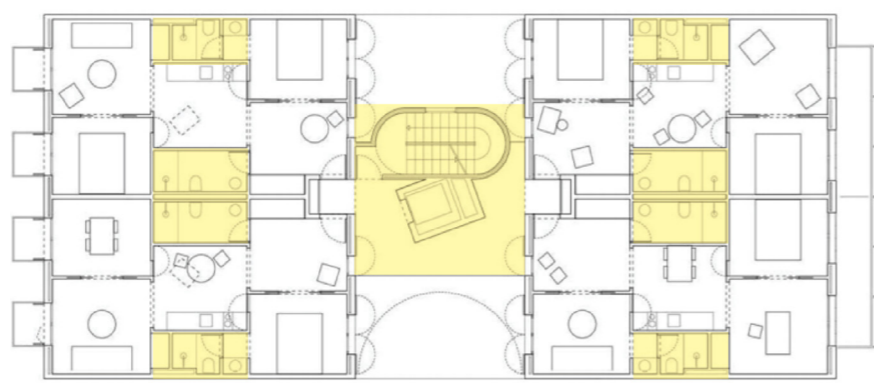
, Planta tipo 110 Rooms, MAIO architects, Barcelona, 2017
